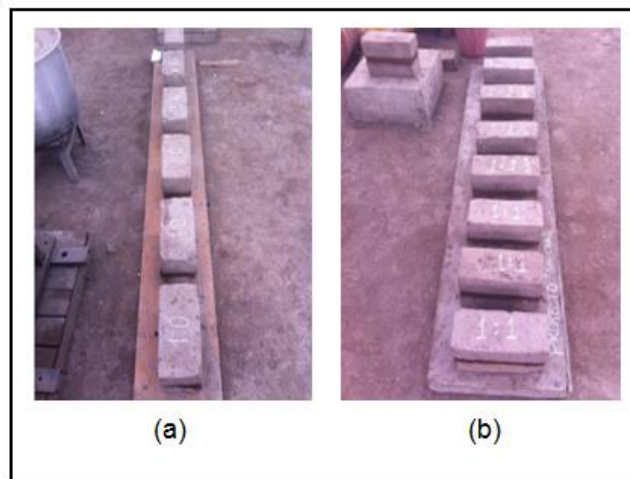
Ensayo de “Control de fisuras” (Fuente: Proyecto Estudio de Aislamiento Sísmico de Viviendas Rurales Mediante Sobrecimientos con Shicras, 2017. En proceso de publicación.)
